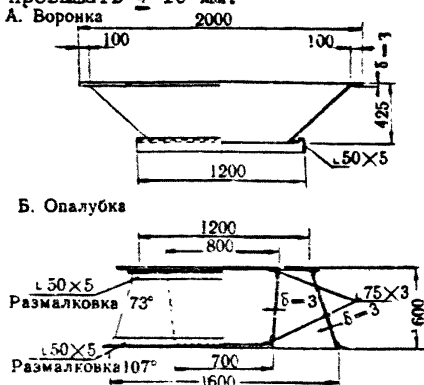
Металлическая опалубка и воронка для бетонирования подколонников
